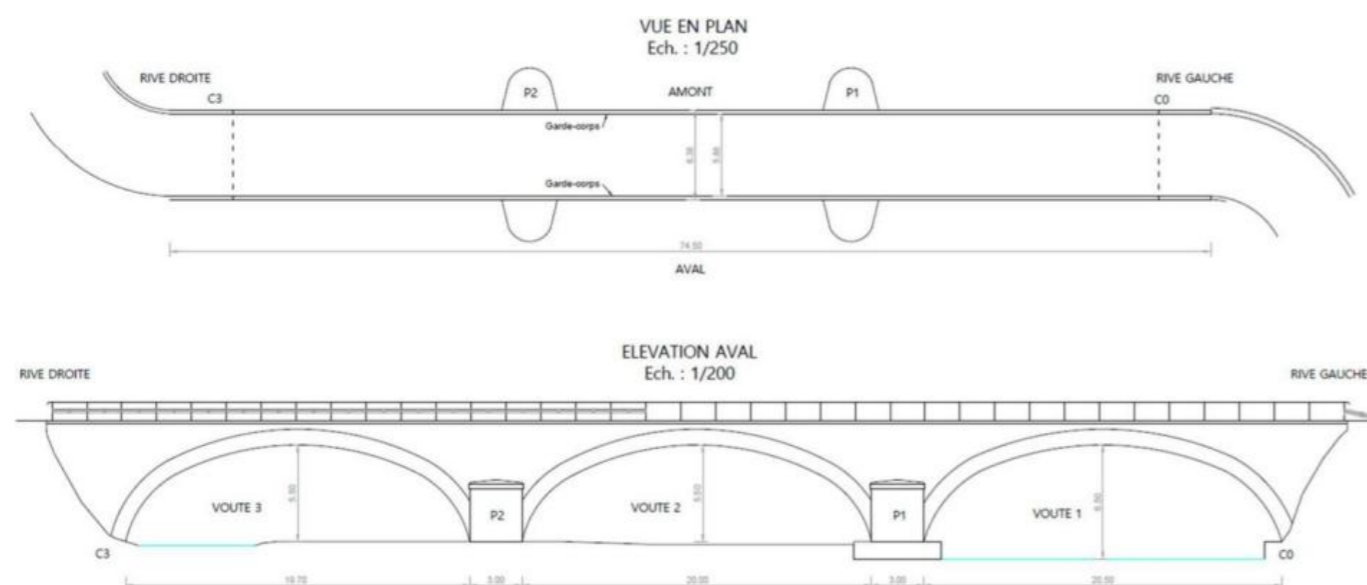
Vue en plan et élévation aval du pont de la Trinité existant
